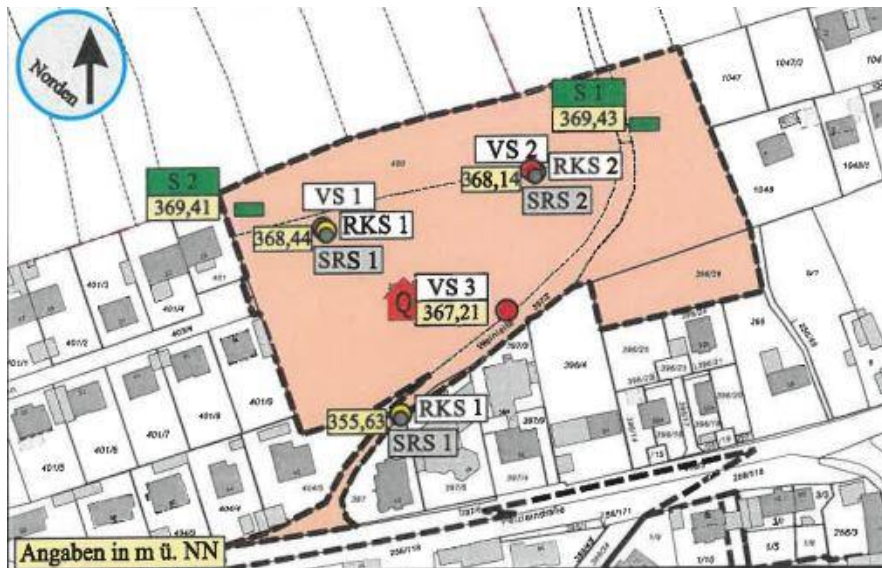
Lageplan Bodengutachten Büro Veith, 30.08.2023
